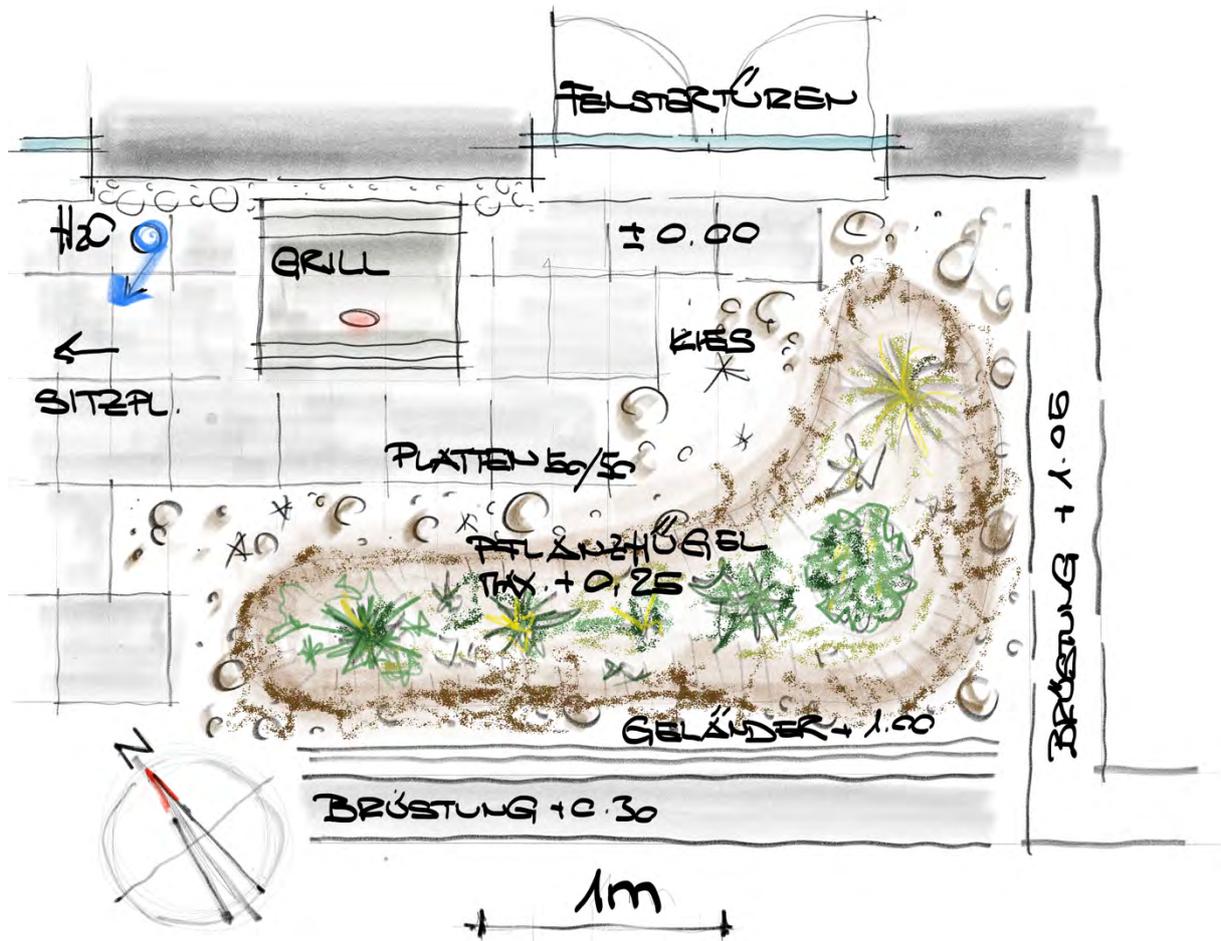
Grundriss Balkon OG mit Plattenbelag und bepflanzter Überhügelung
